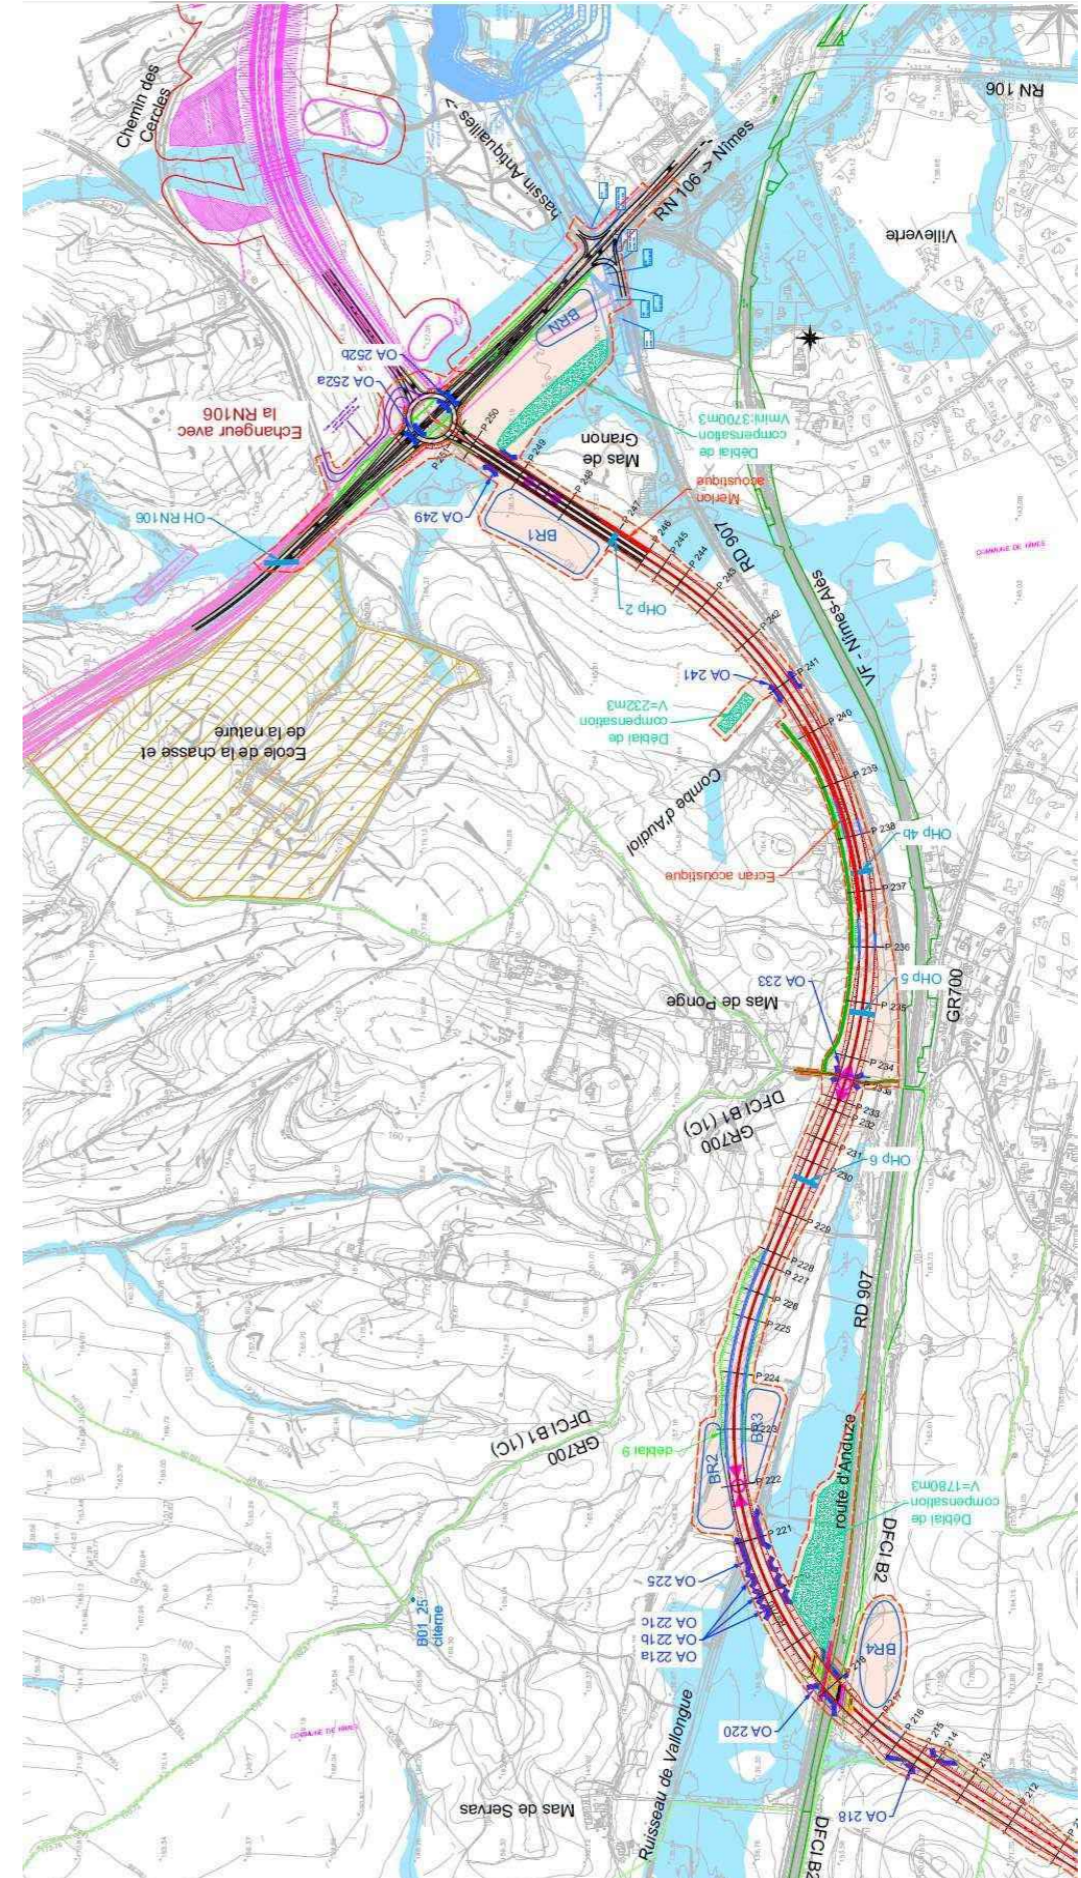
Plan de masse du projet - Secteur Nord (Source : Présents, Juin 2021)
